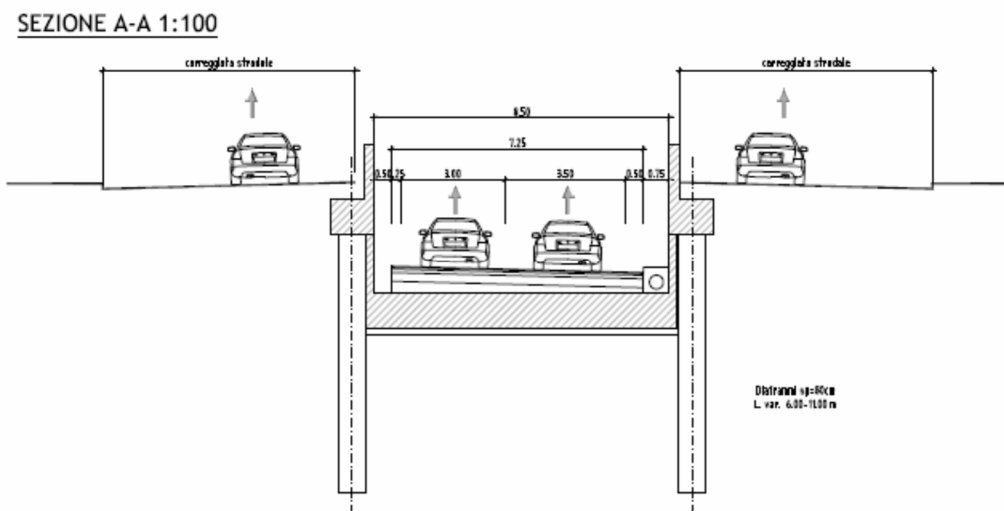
Sezione trasversale rampe di accesso (estratto da elaborato B831-C-SF-STR-RT001A)
